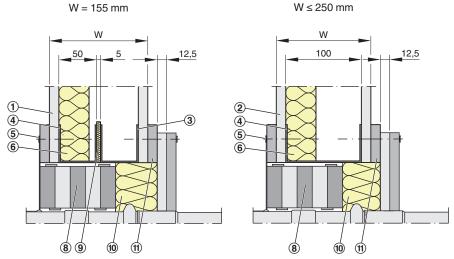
Trockeneinbau in F30-Leichtbauwände mit W ≥ 155 mm (mit Laibung / ohne Laibung)
